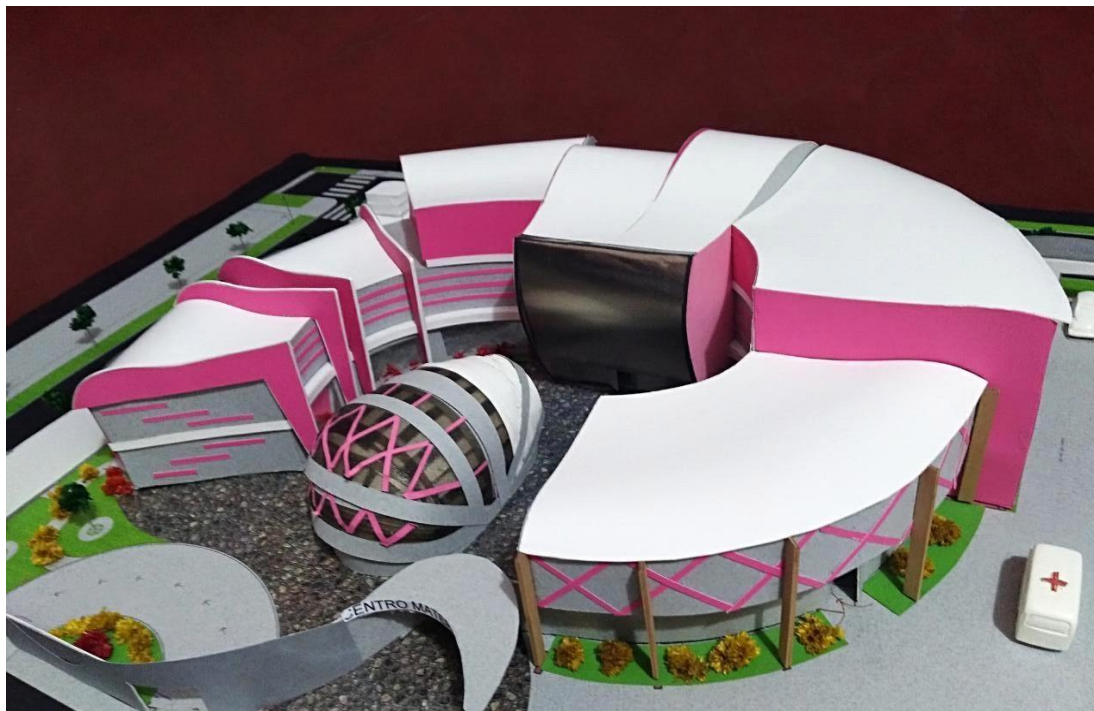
Fachada Lateral Derecho. Maqueta detallada de propuesta de equipamiento.
